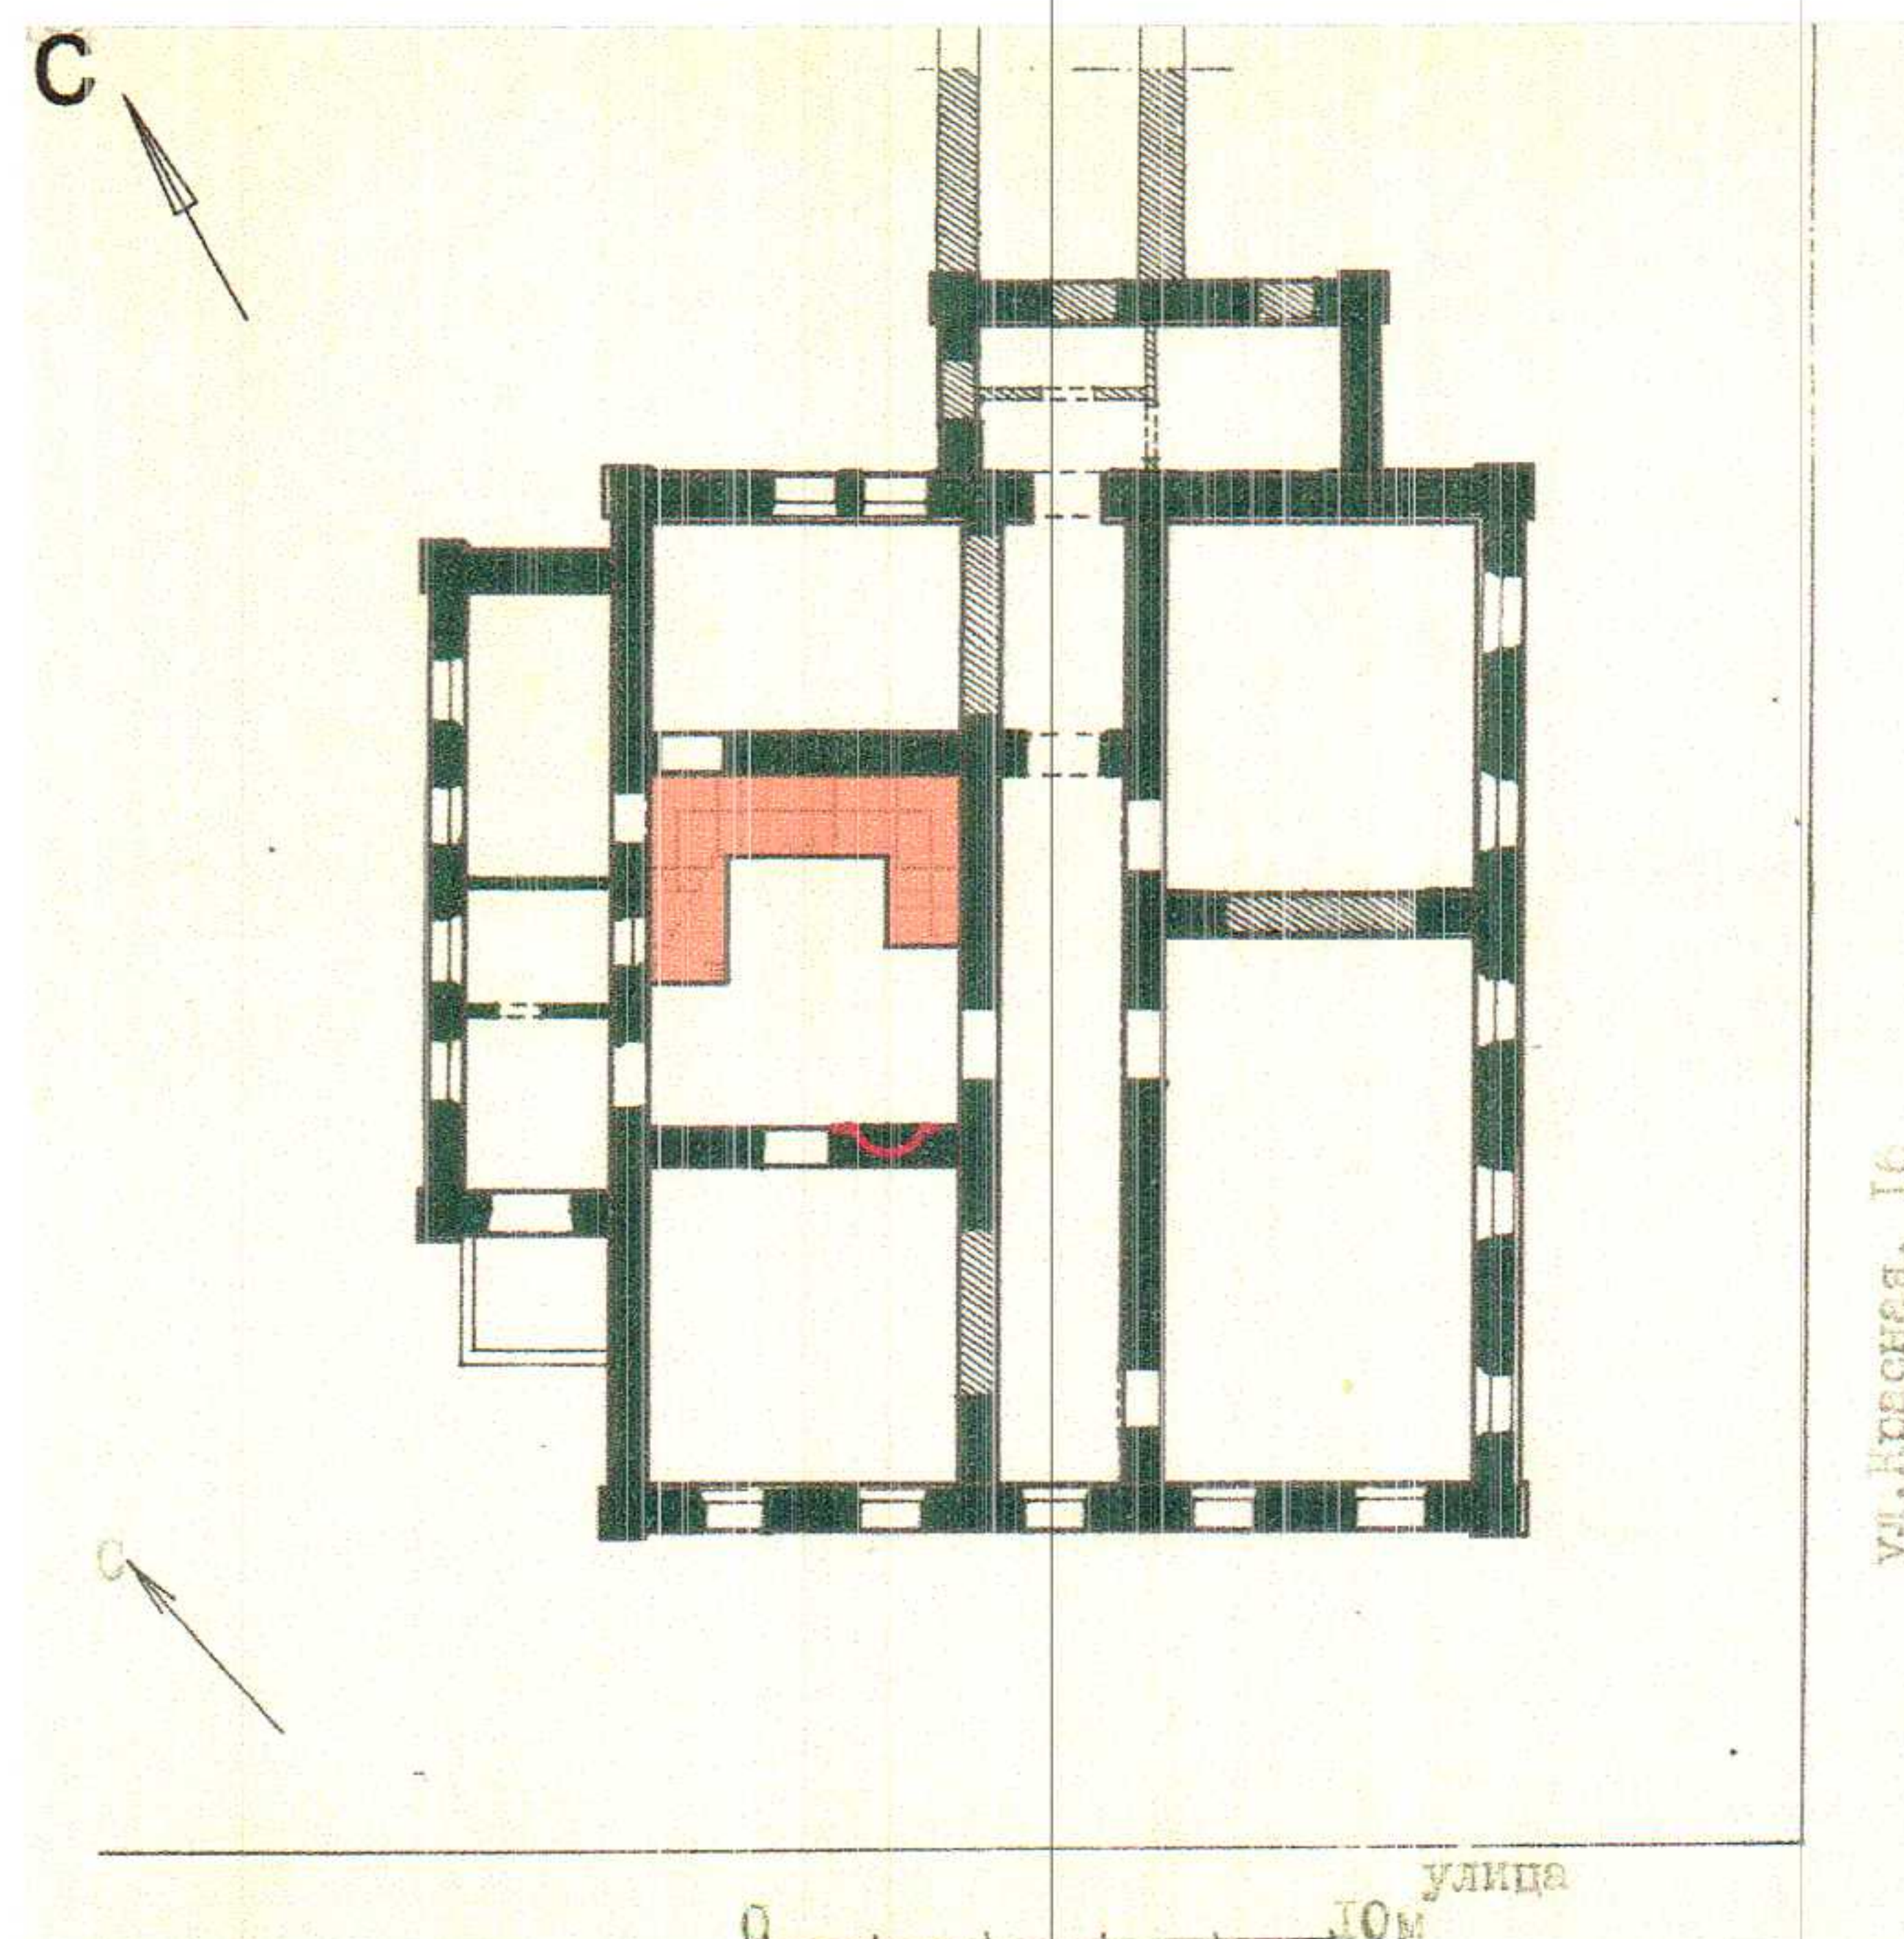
Схема выполнена на основе чертежа плана первого этажа от 14.07.1992 г.
